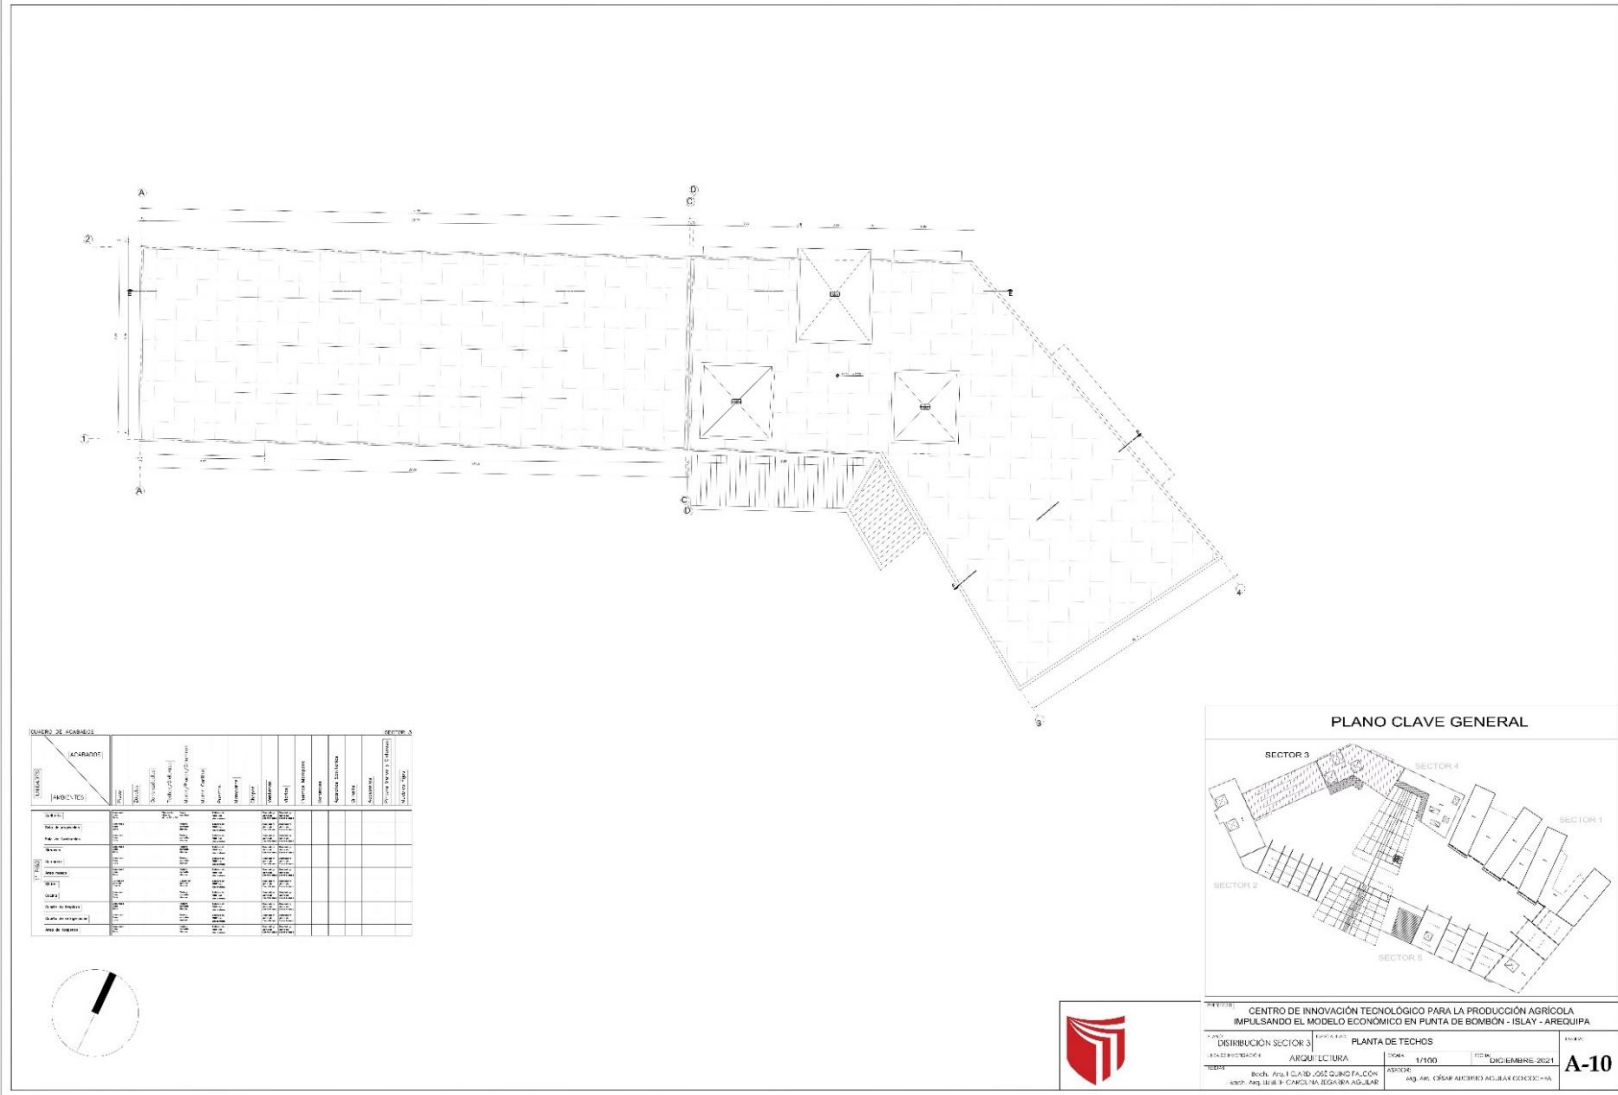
A – 10 Sector 3 - Plano de Distribución de Planta de Techos.
